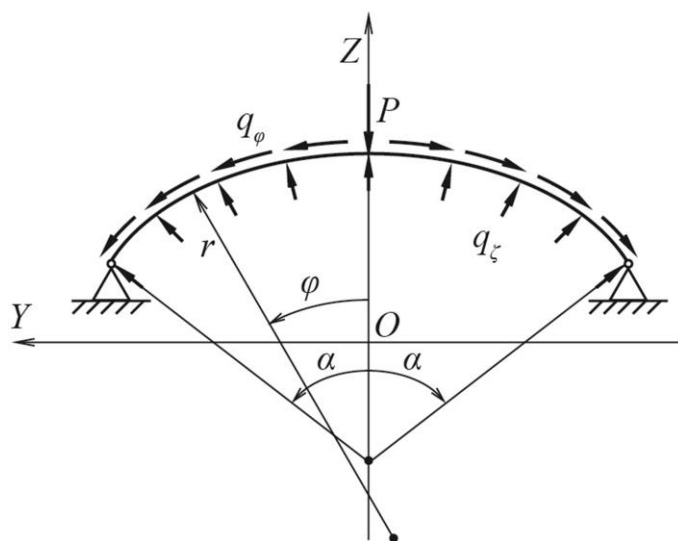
Відкрита некругова циліндрична оболонка з шарнірно опертими повздовжніми краями
